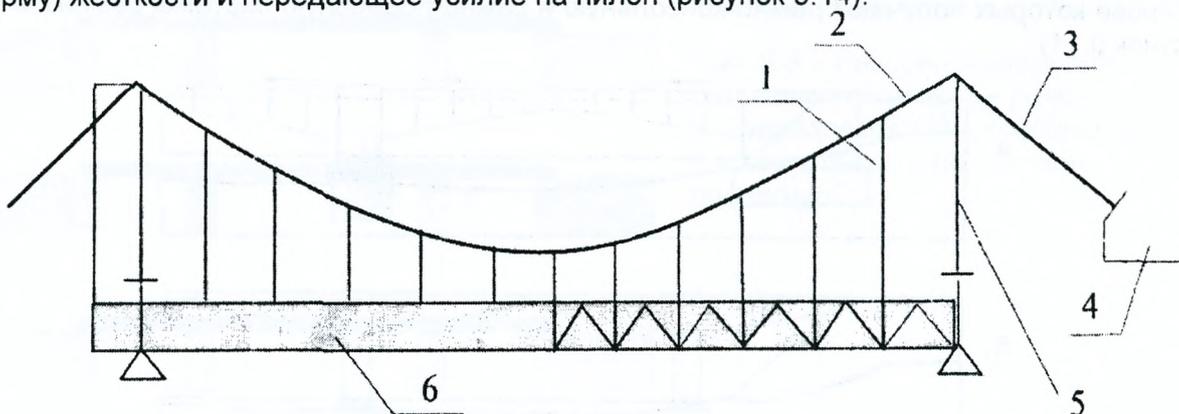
Схема висячего моста: 1 – подвеска; 2 – нить; 3 – оттяжка; 4 – анкерная опора; 5 – пилон; 6 – балка жесткости
